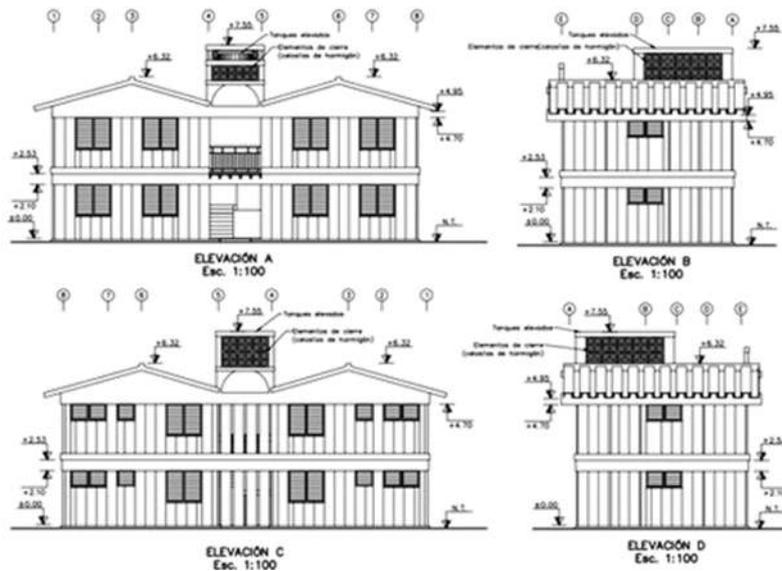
Elevaciones principales del bloque de cuatro viviendas económicas de una habitación cada una. Edificación de dos niveles proyectada empleando el sistema constructivo SERF.
